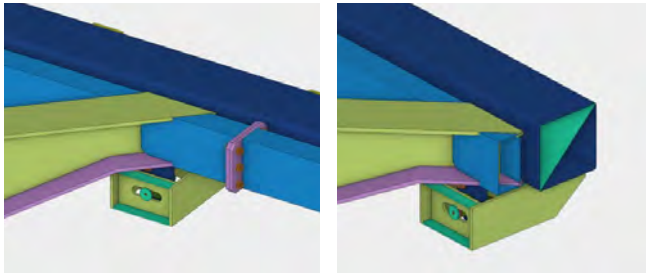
Detalle de apoyo de vigas principales en estructura de fondo y lateral.
